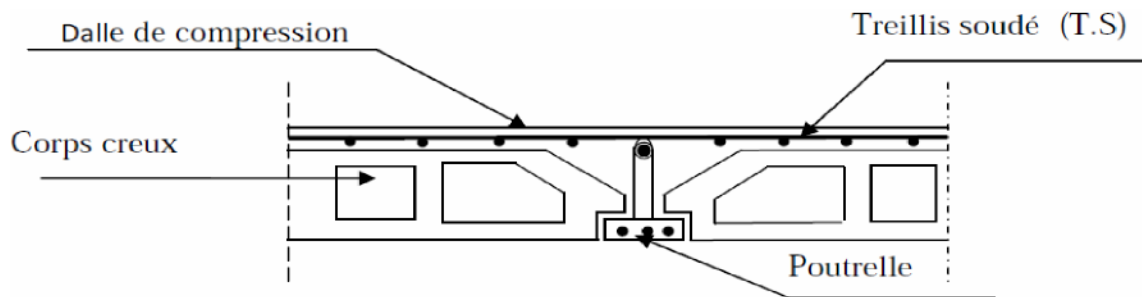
Coupe transversale d'un plancher en corps creux
